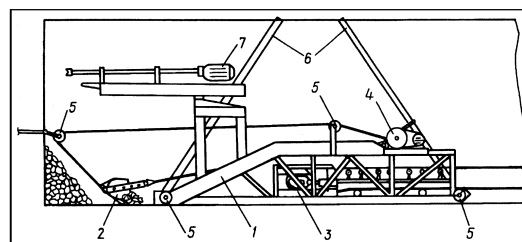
Схеми скреперного комплексу: 1 - естакада; 2 - скреперний ківш; 3 - стрічковий конвеєр; 4 - скреперна лебідка; 5 - система блоків; 6 - упорні стояки; 7 - електродвигун бурильного станка.
